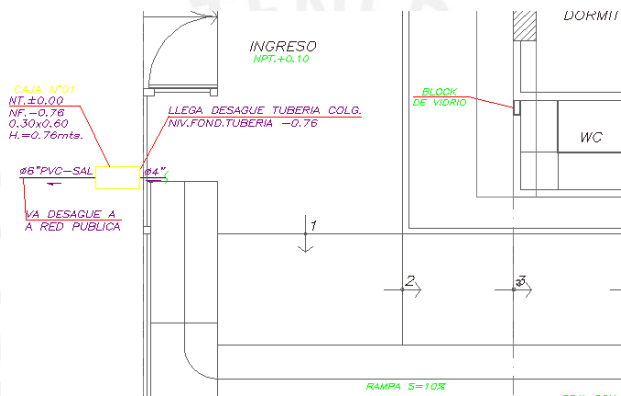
°.- Planta con ubicación de Caja de Desagüe
